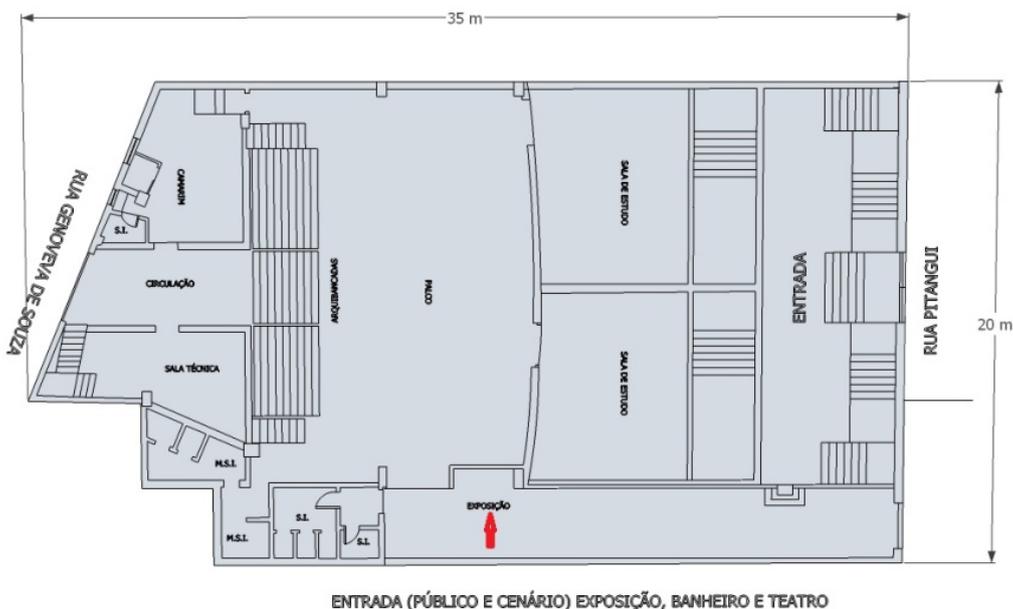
Planta baixa do primeiro piso do edifício do Galpão Cine Horto.
